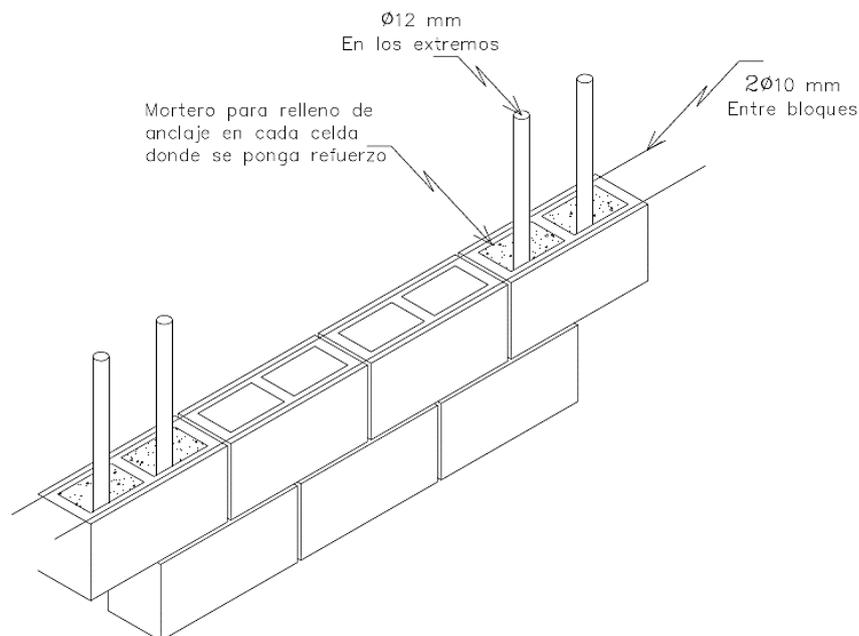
Detalle esquemático de los refuerzos longitudinales y transversales en el muro.
